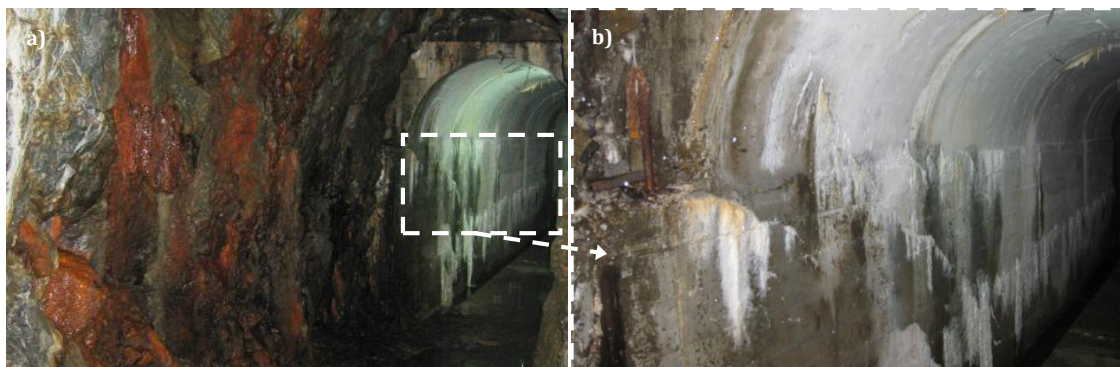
Interacción suelo-estructura en galerías; a) vista general b) detalle fisura
